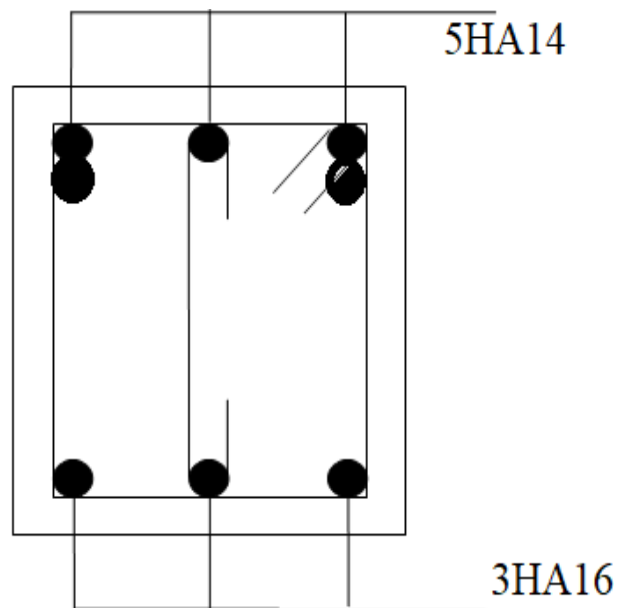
Schéma de ferraillage de la poutre brisée.
